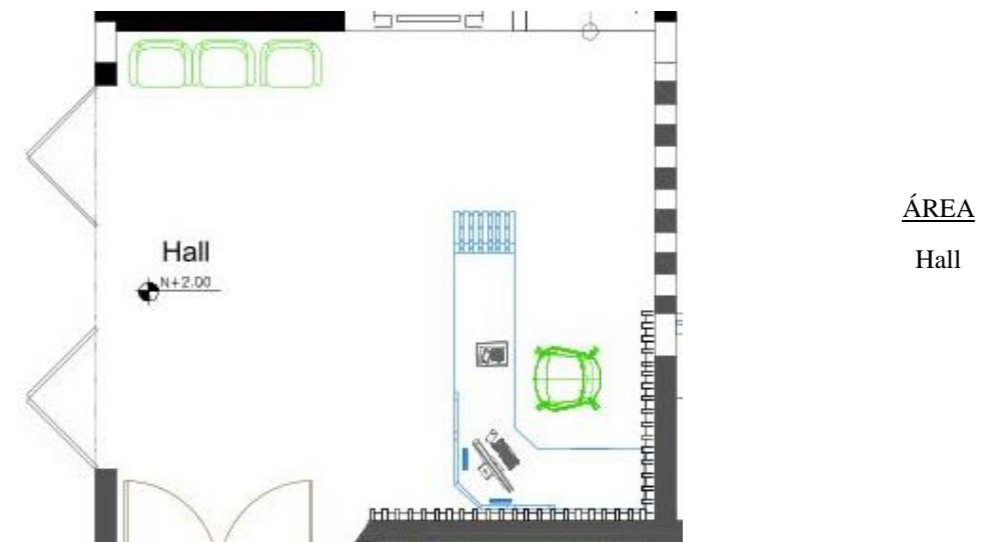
hall- área administrativa/ orientación - (Planta Baja)
